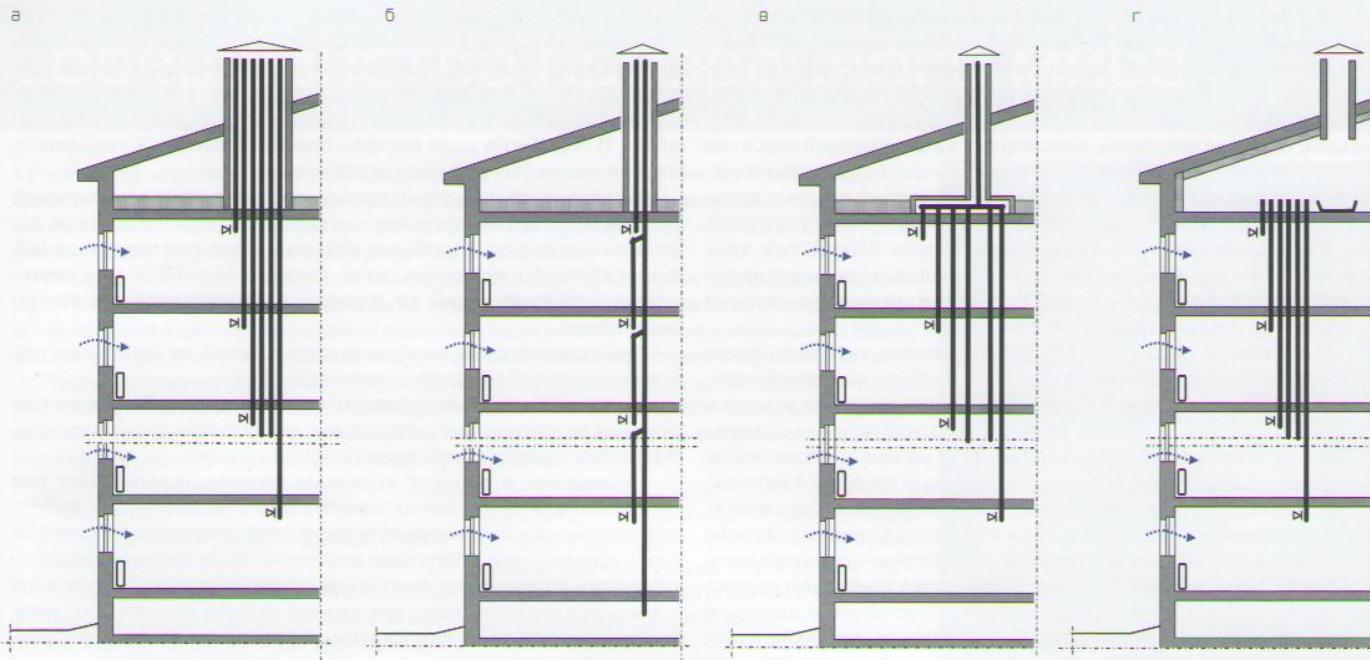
Принципиальные схемы некоторых систем естественной вентиляции жилых зданий:
